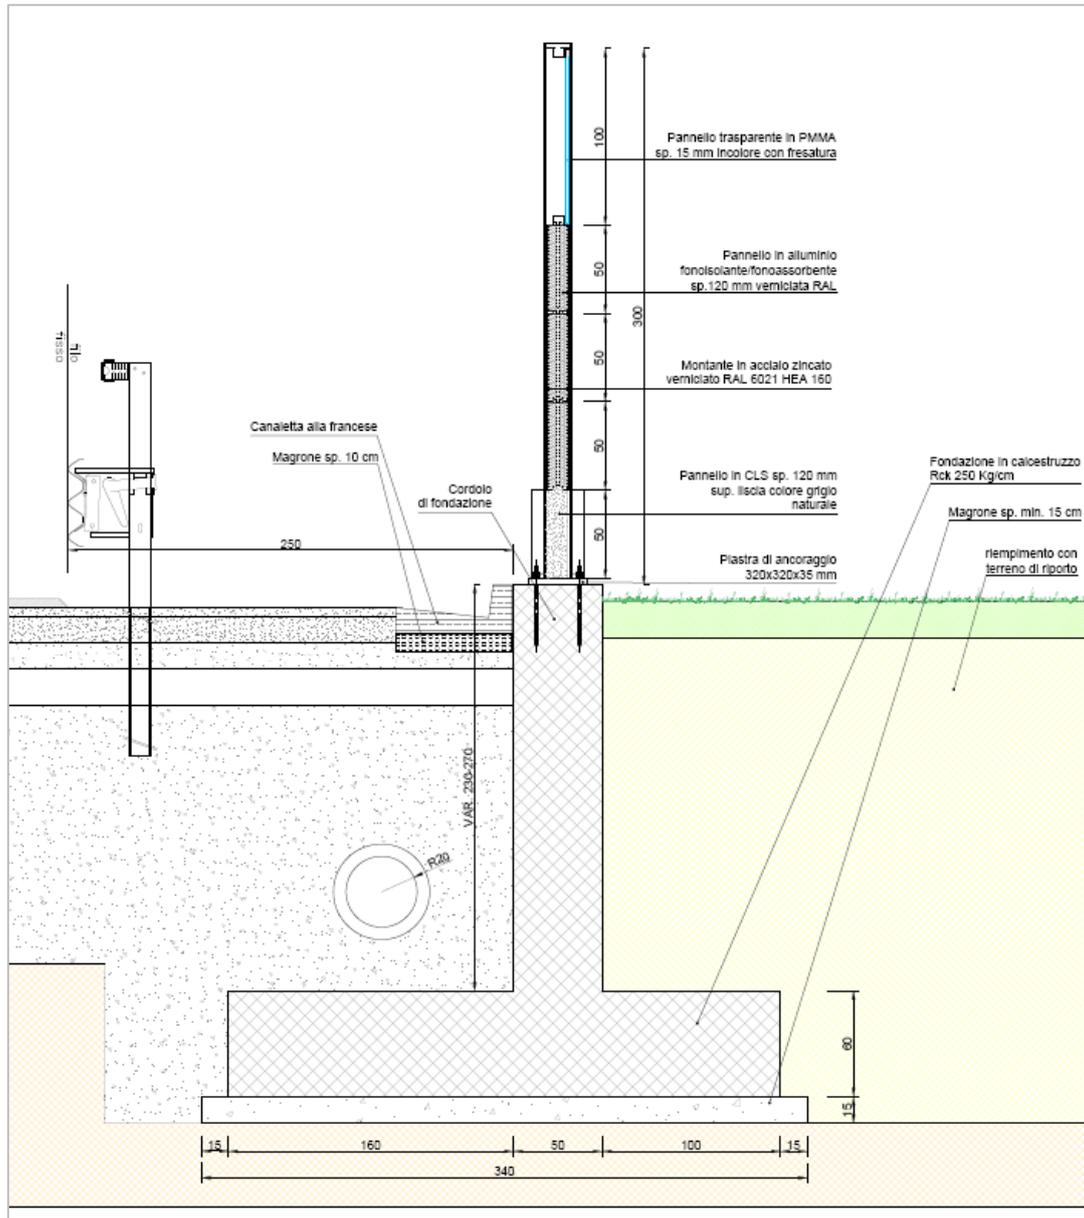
/1 Fondazione tipo 1 – Muro di altezza fino a 2,5 m
